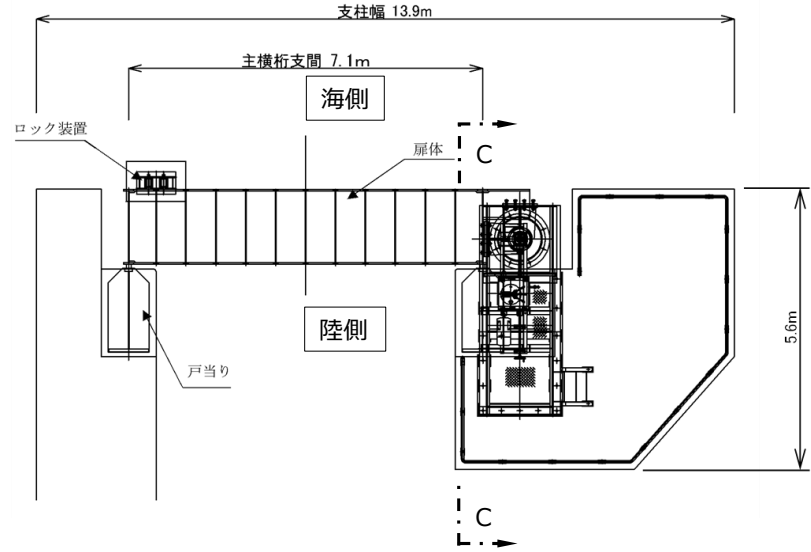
(2) 漂流物対策工の構造図 (鋼製扉体平面図, B-B 断面)
